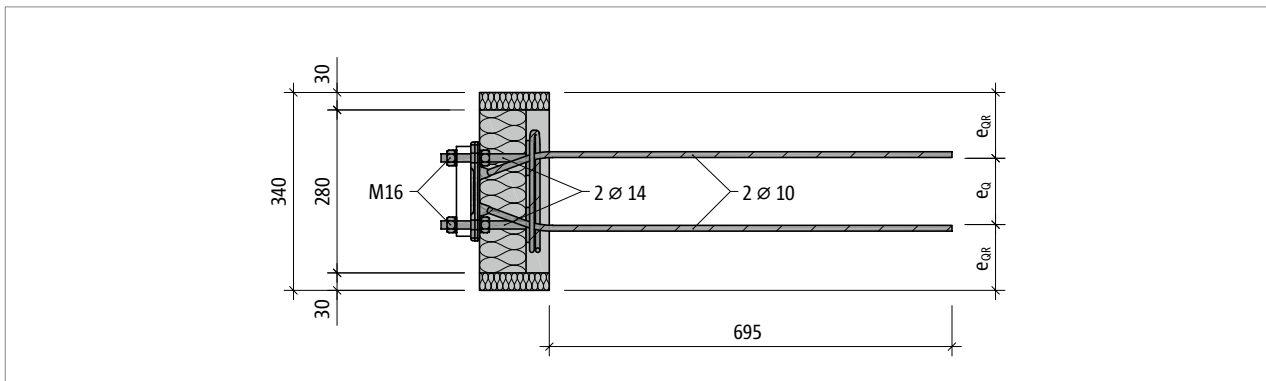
Schöck Isokorb® RT Typ SQ-V2: Produktgrundriss
